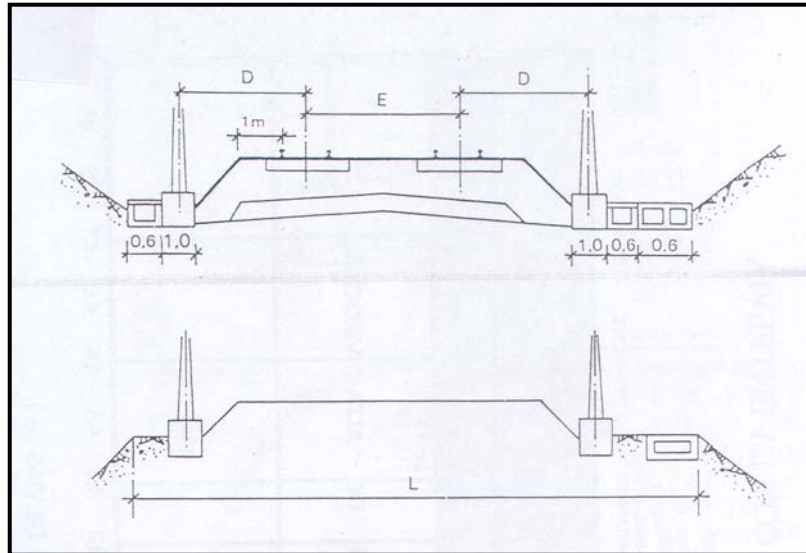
Sección tipo de en vía doble, mostrando las distancias L y D de la anterior tabla.
